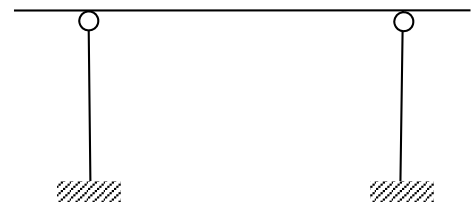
Pórtico metálico con extremo superior de columnas articuladas
